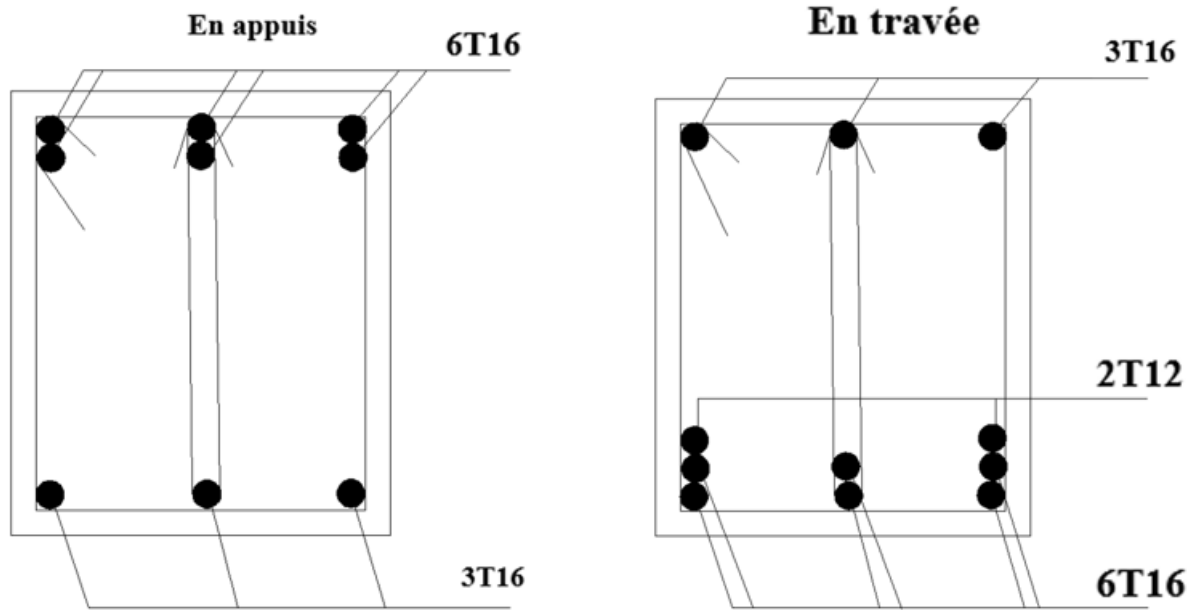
Schéma de ferrailage de la poutre secondaire (50 x 30) cm².
